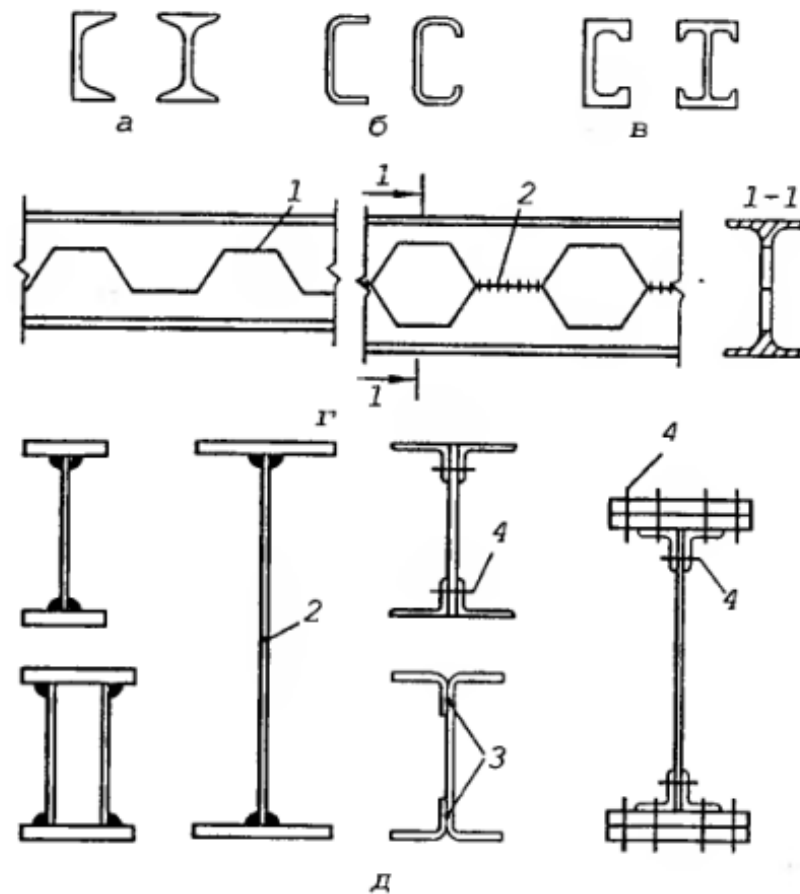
Приклади поперечних перерізів сталевих балок: а – прокатні; б – гнуті; в – пресовані; г – з перфорованою стінкою; д – складеного перерізу; 1 – лінія розрізу; 2 – зварний шов; 3 – точкове зварювання; 4 – болтове або заклепкове з'єднання
